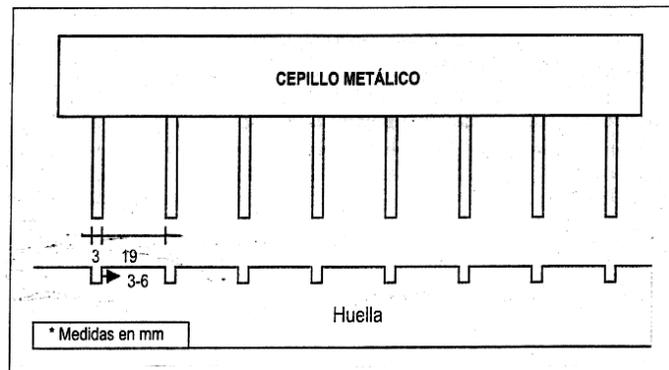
Dimensiones del cepillo metálico para el macro texturizado de las losas y reparachos en pavimento rígido
